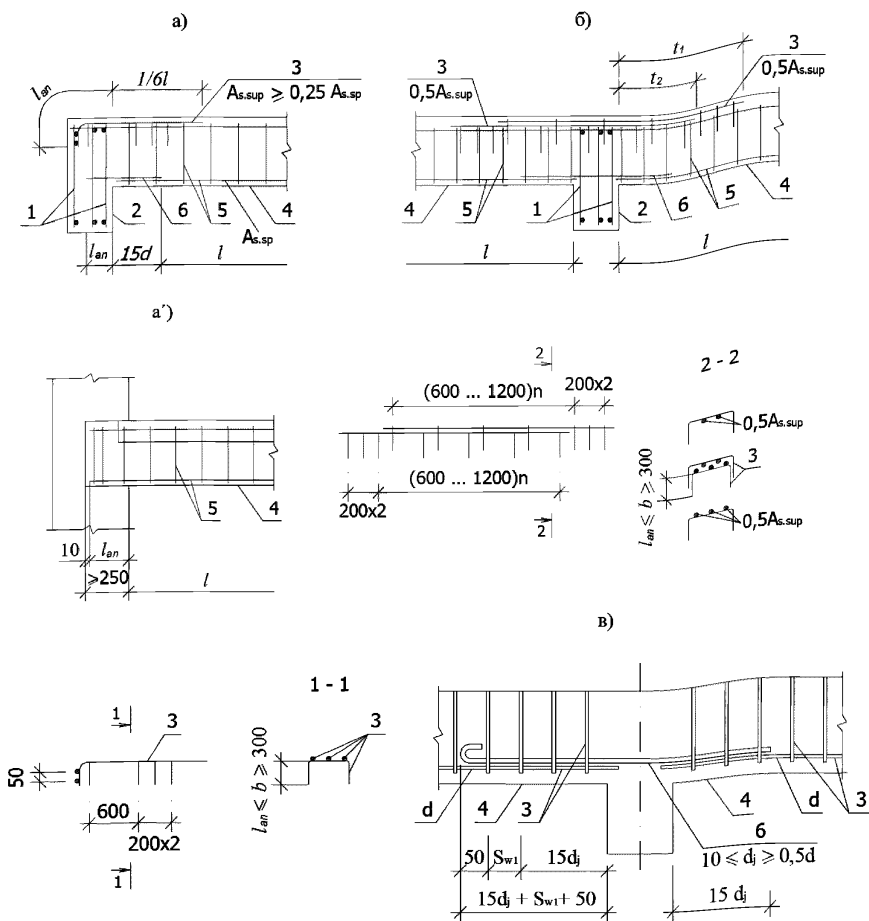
Армирование второстепенных монолитных балок сварными сетками:
